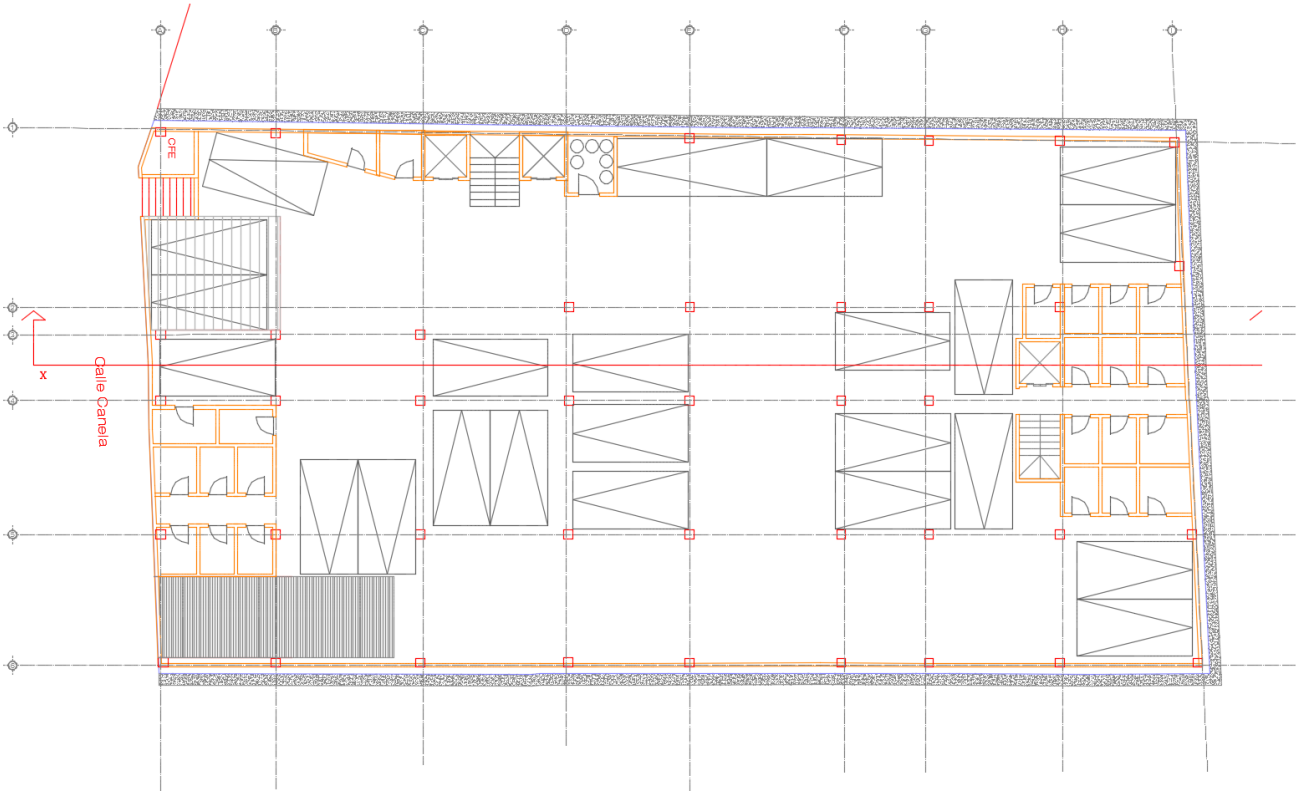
PLANTA ARQUITECTÓNICA PLANTA BAJA
